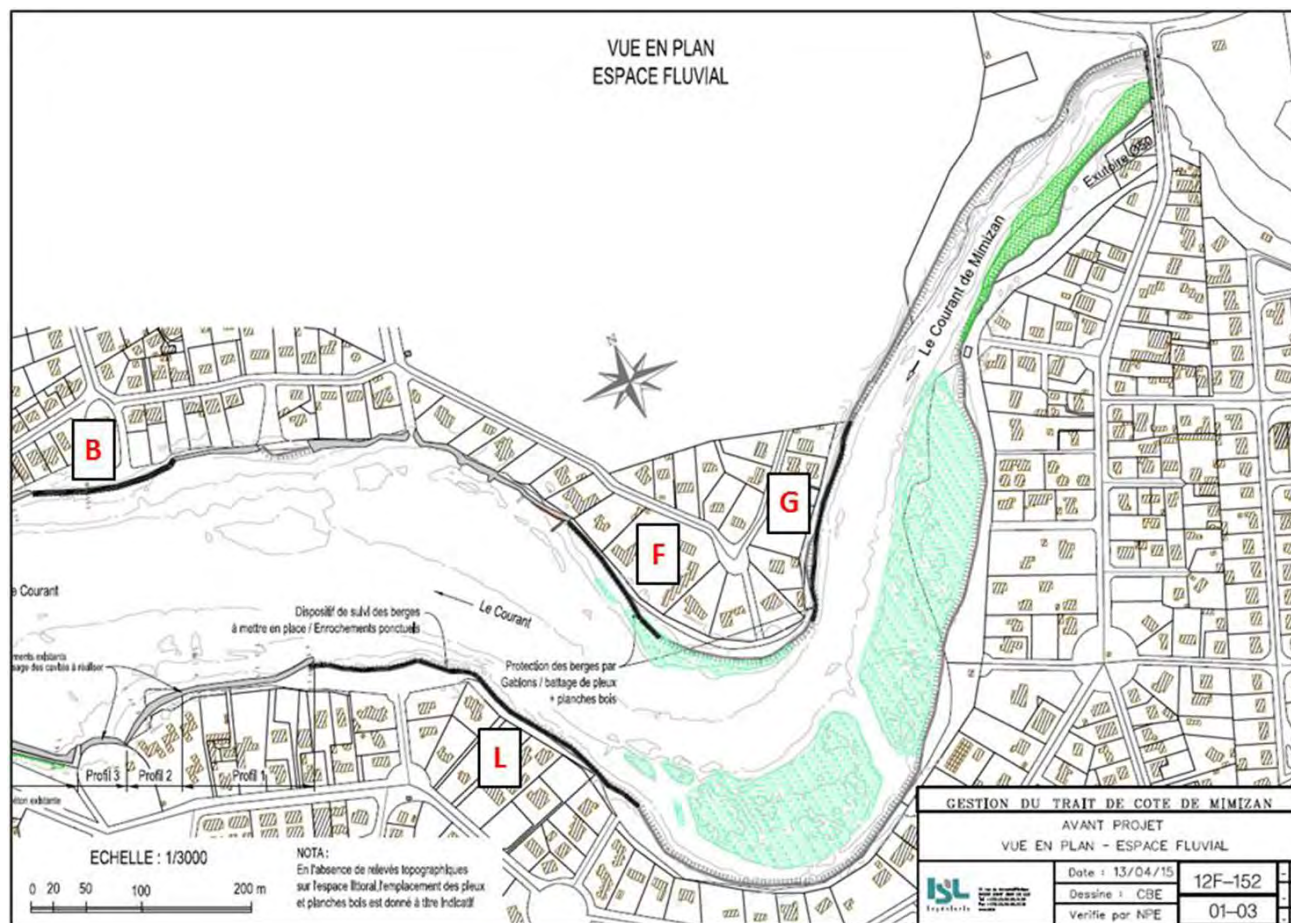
Vue en plan de l'espace fluvial et localisation des profils de travaux
